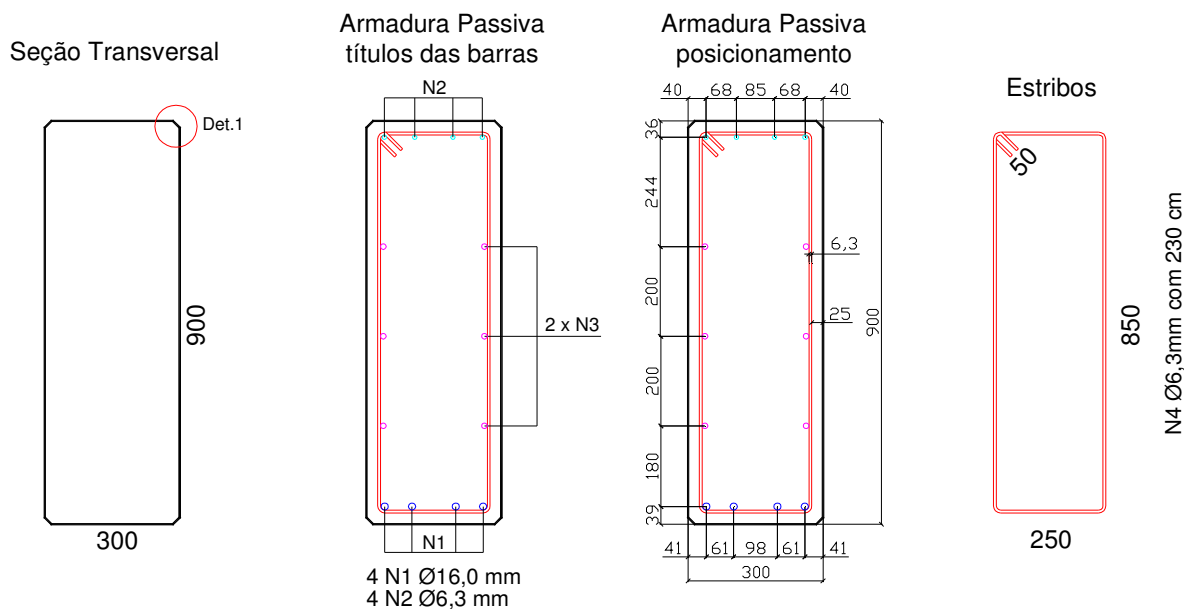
Detalhe das armaduras passivas para concreto protendido e CAA III e IV.
